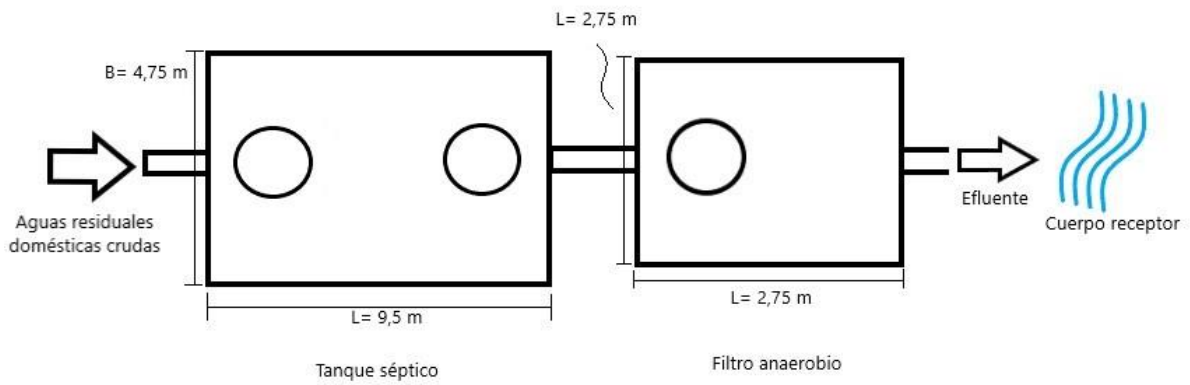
Vista en planta del sistema tanque séptico y filtro anaerobio.
